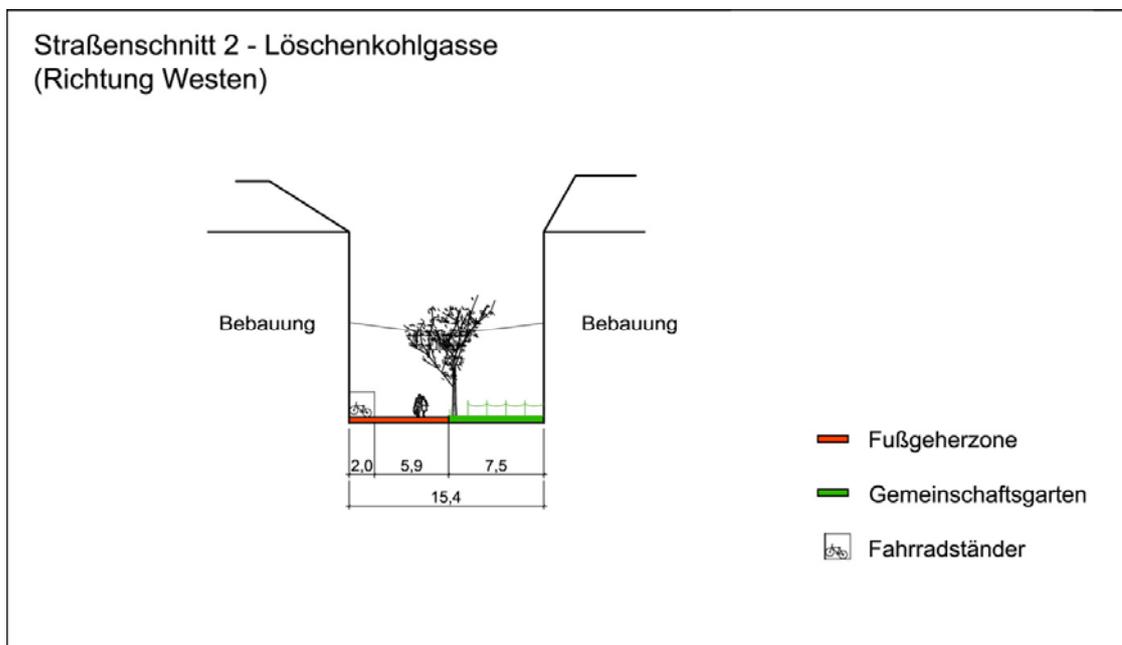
Entwurf - Straßenschnitt Löschenkohl-gasse - Richtung Westen (Quelle: eigener Entwurf, 2008)
